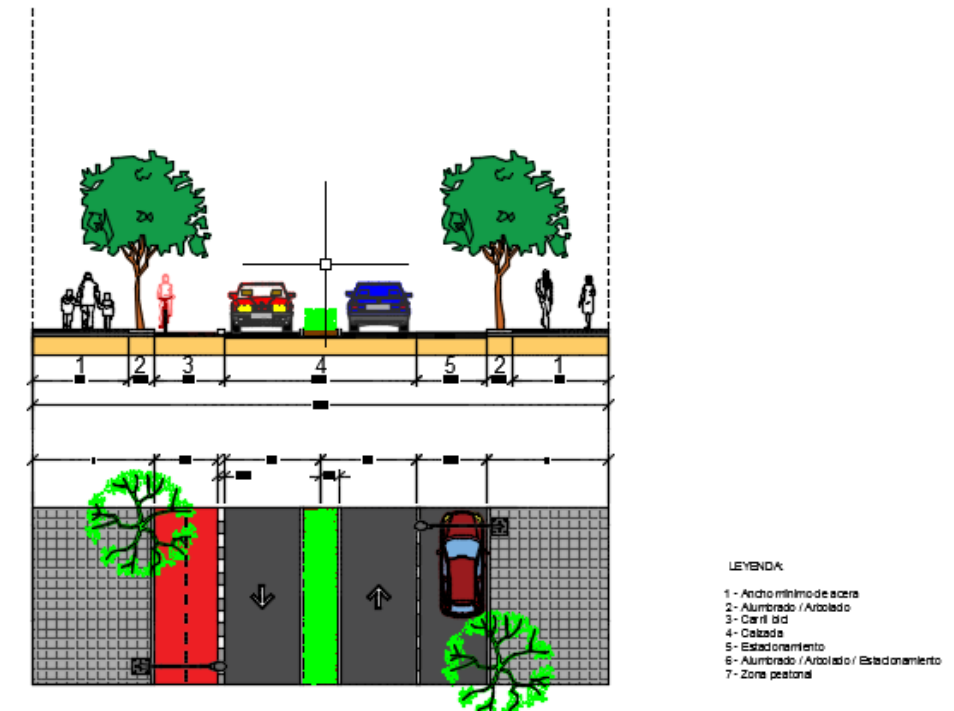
Avenida Corona de Aragón. Sección tras la actuación.
